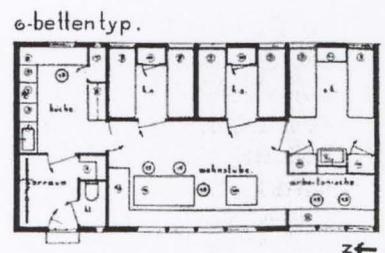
1926 Otto Haesler, Kabinengrundriss 6-Bettentyp, Wohnfläche 48.9m²
